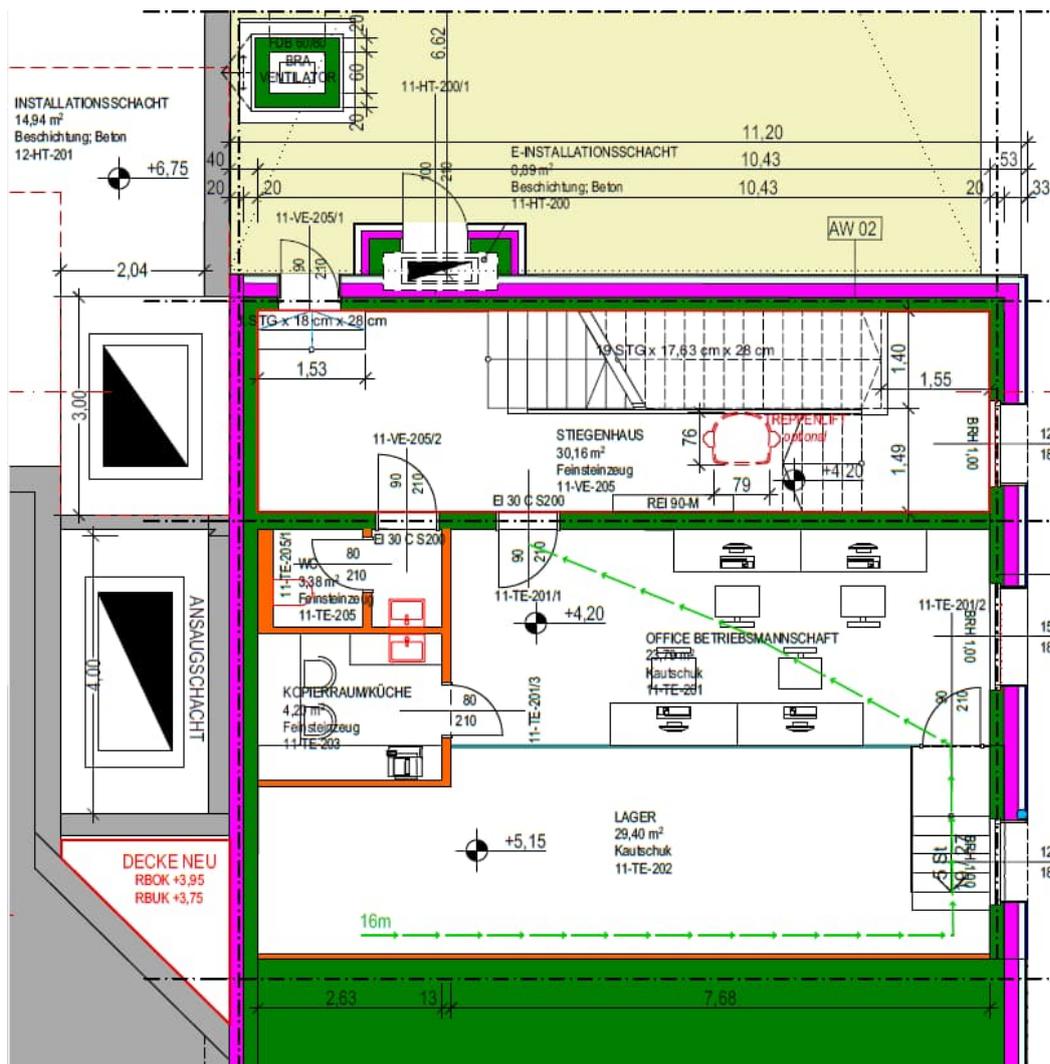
1. Obergeschoss. Details können dem Plan „B.03-01 P02 2.0 A Grundriss 1. Obergeschoss und 2. Obergeschoss inkl. Dachdraufsicht“ entnommen werden.
